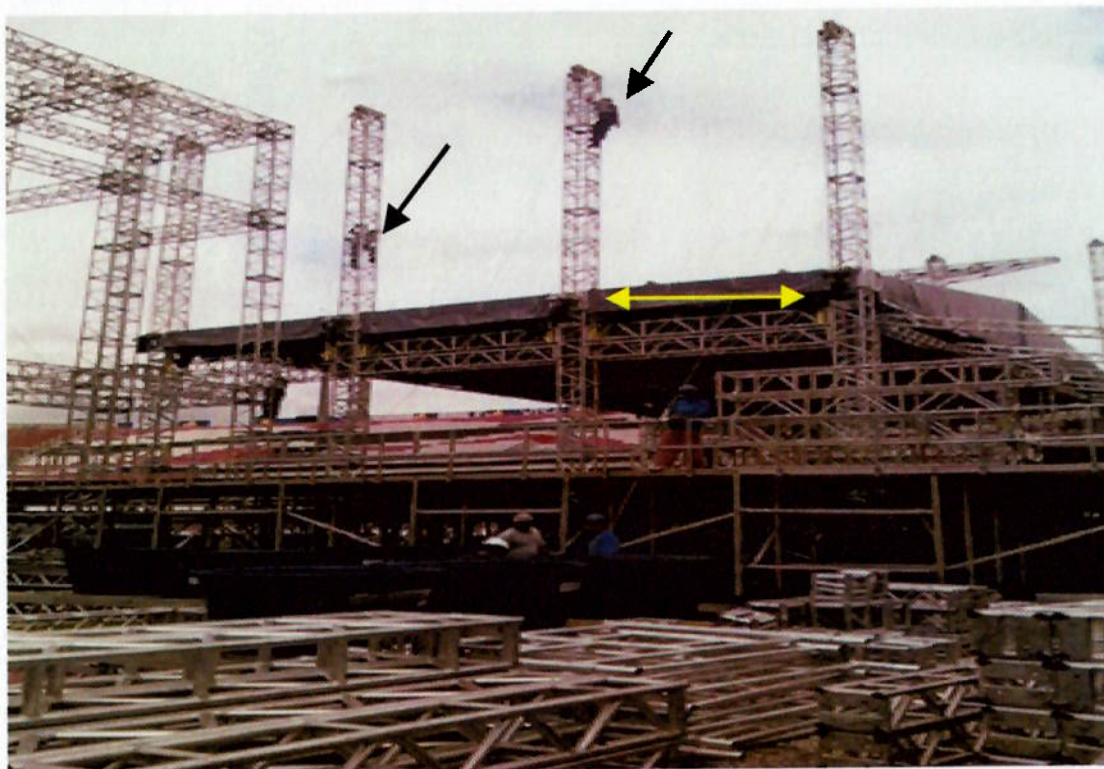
Montadores instalando talhas para içamento de palco e conexão do teto do palco com torres – (Sleeves)
